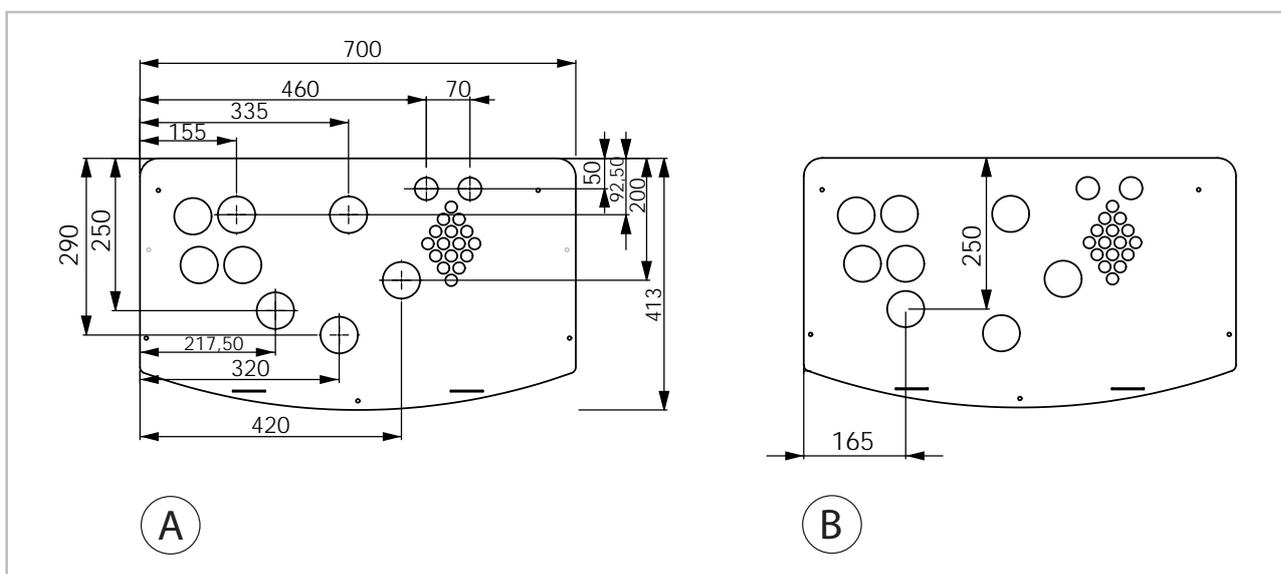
Agencement des embouts de tuyaux WKF 70/120/180 (Toutes les dimensions en mm)
